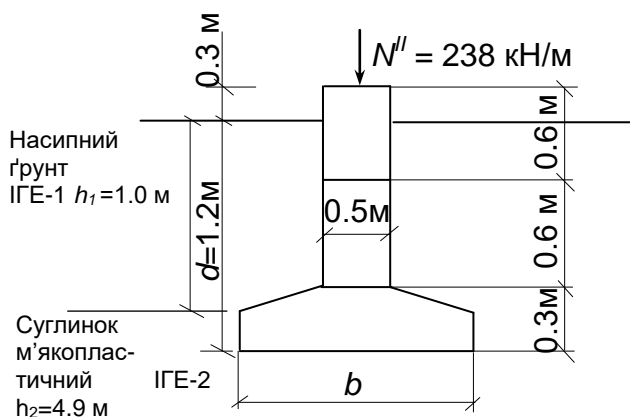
Розрахункова схема фундаменту по перерізу 1–1
